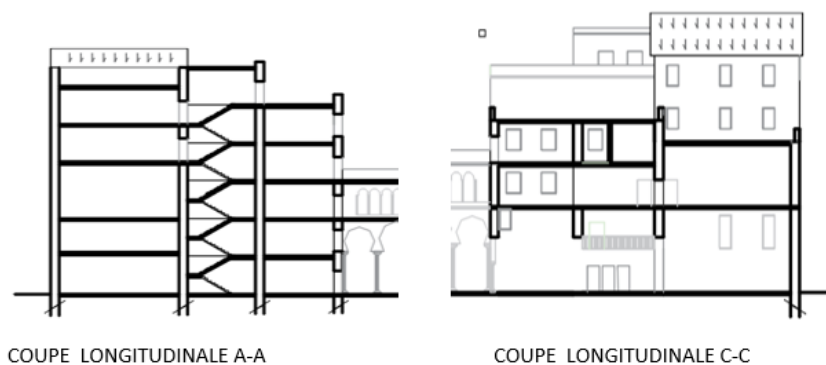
Coupe Longitudinale A-A et C-C du bloc 06
